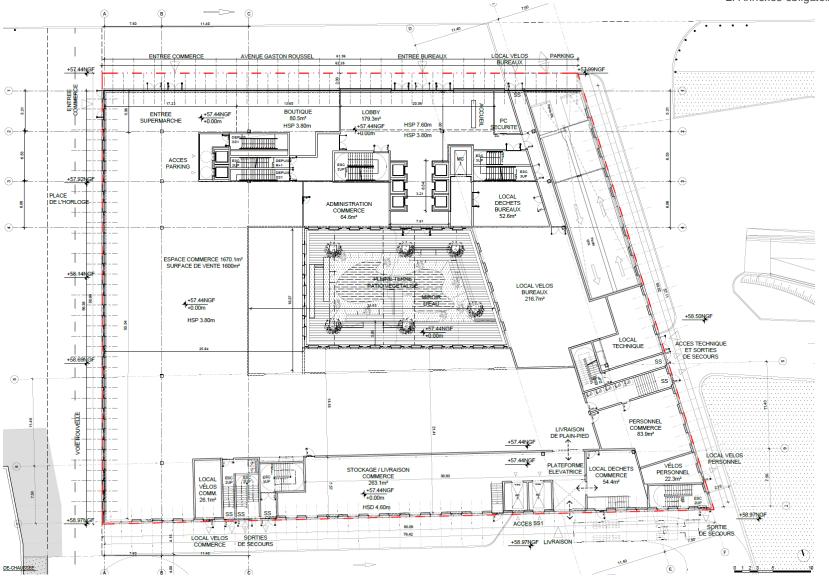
Plan du rez-de-chaussée (source : Wilmotte et Associé, décembre 2019)
